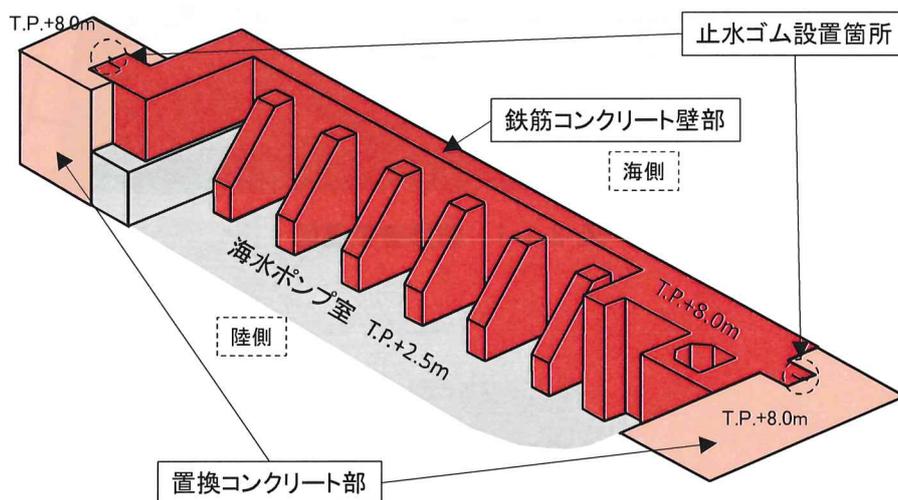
防護壁鳥瞰図（鉄筋コンクリート壁部）
